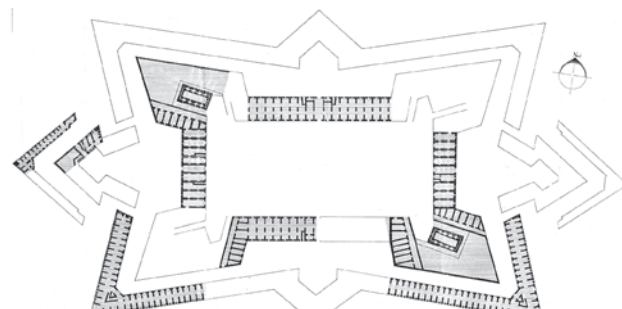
Plan de la cité sur Ada Kaleh, avec des propositions visant le déplacement sur Șimian. Archives de l'INP.
